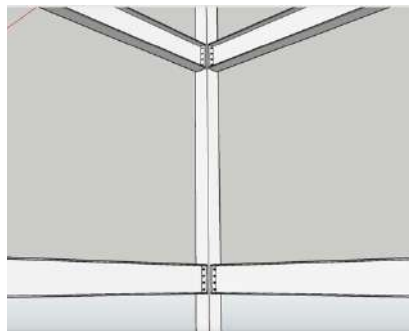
Rangka Space Frame (sumber : stadiumdb.com)
